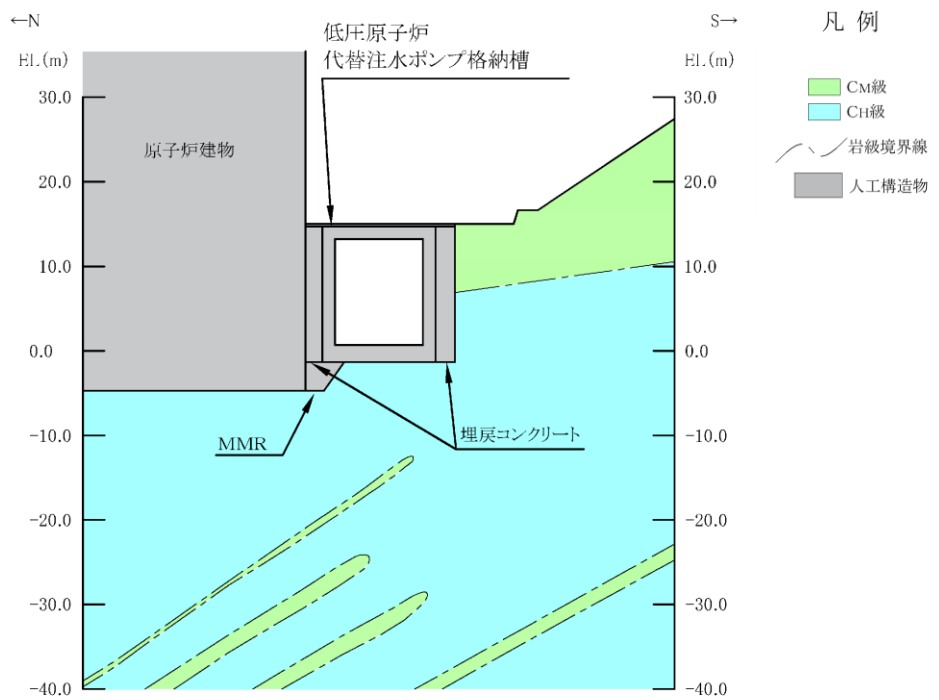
低圧原子炉代替注水ポンプ格納槽 評価対象断面図 (B-B 断面位置)
